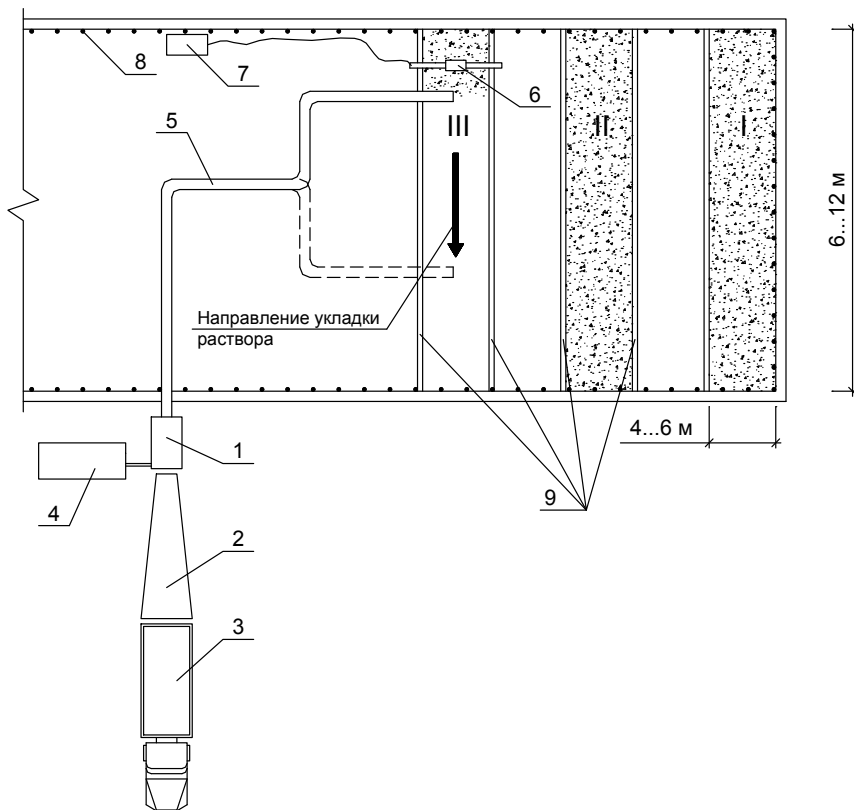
Технологическая схема производства работ по устройству монолитной теплоизоляции:
